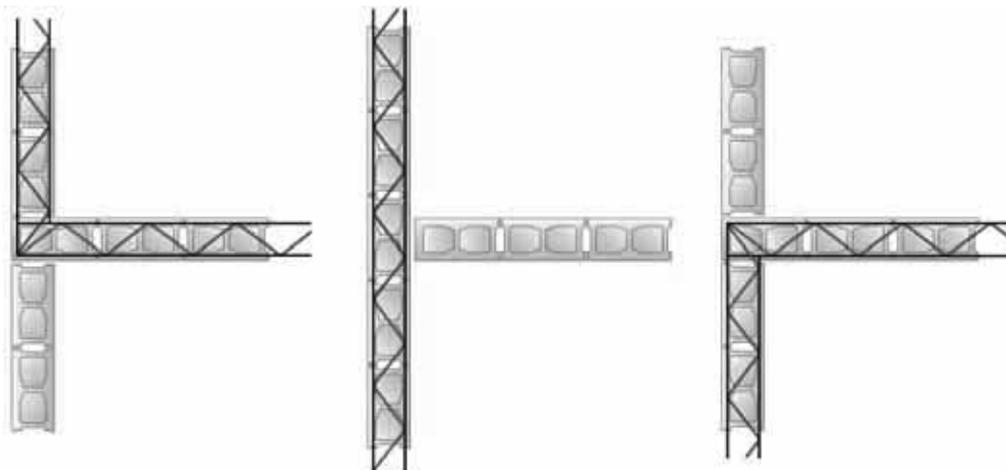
Encuentro de muros de fábrica armada. Disposición de la armadura de tendel en hiladas alternas.
